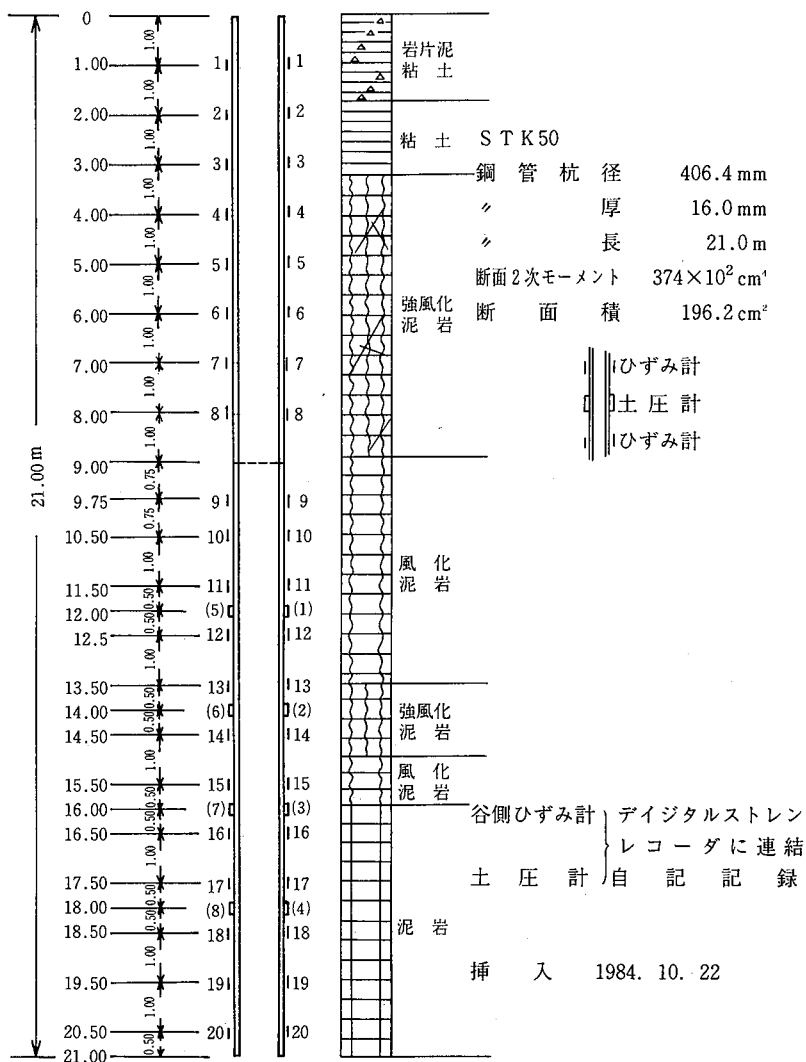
No. 20 歪鋼管杭歪計・土圧計配置図
